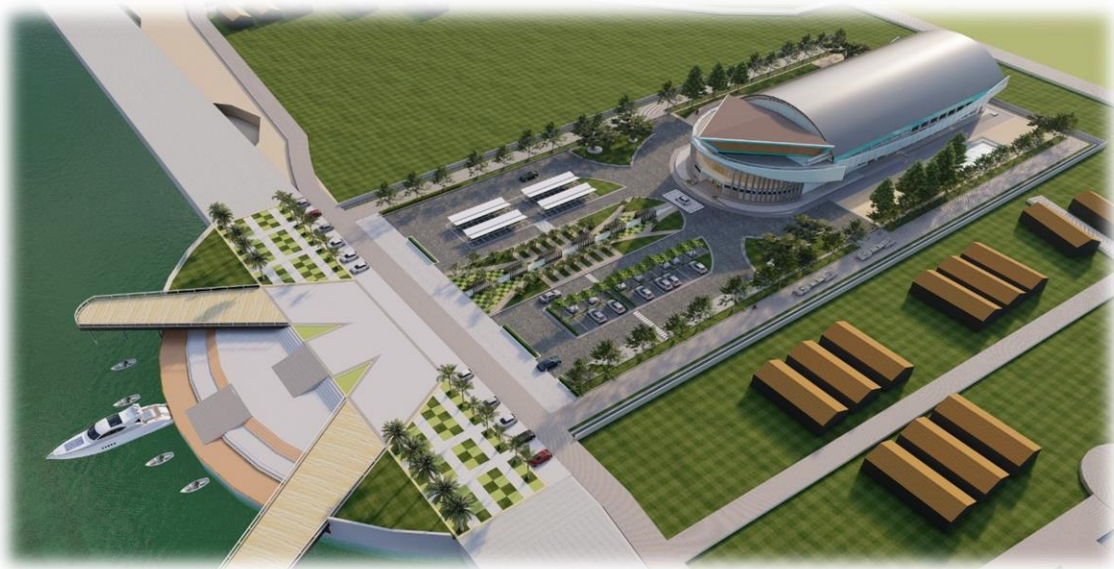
Konsep Pewarnaan Dan Tekstur Pada Bangunan
